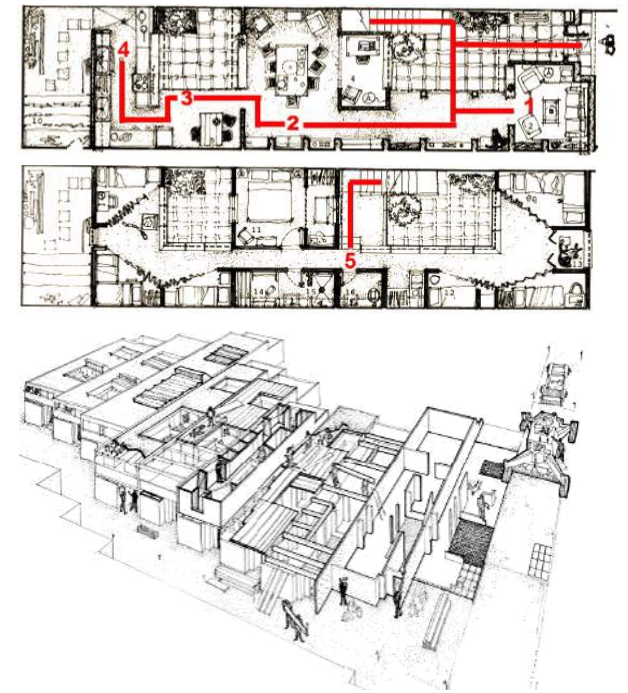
Recorrido de la planta baja y primera de las viviendas de PREVI de Alexander y proceso de construcción ampliable
